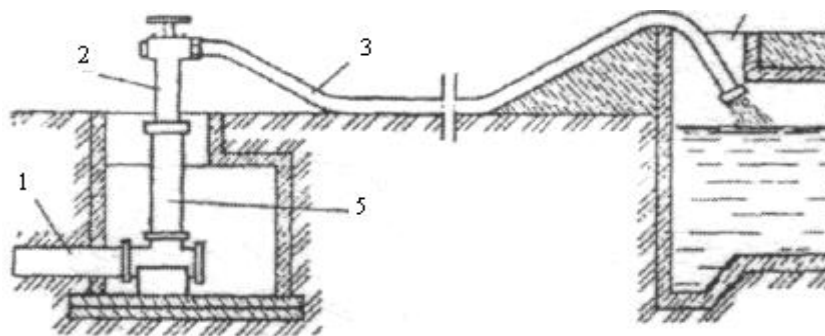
Наповнення пожежної водойми з пожежного гідранта:
